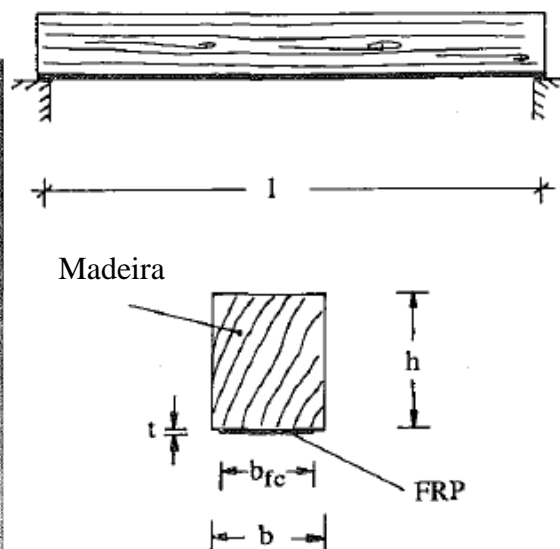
Solução construtiva adoptada por (Plevris & Triantafillou, 1992) no reforço de vigas de madeira.
